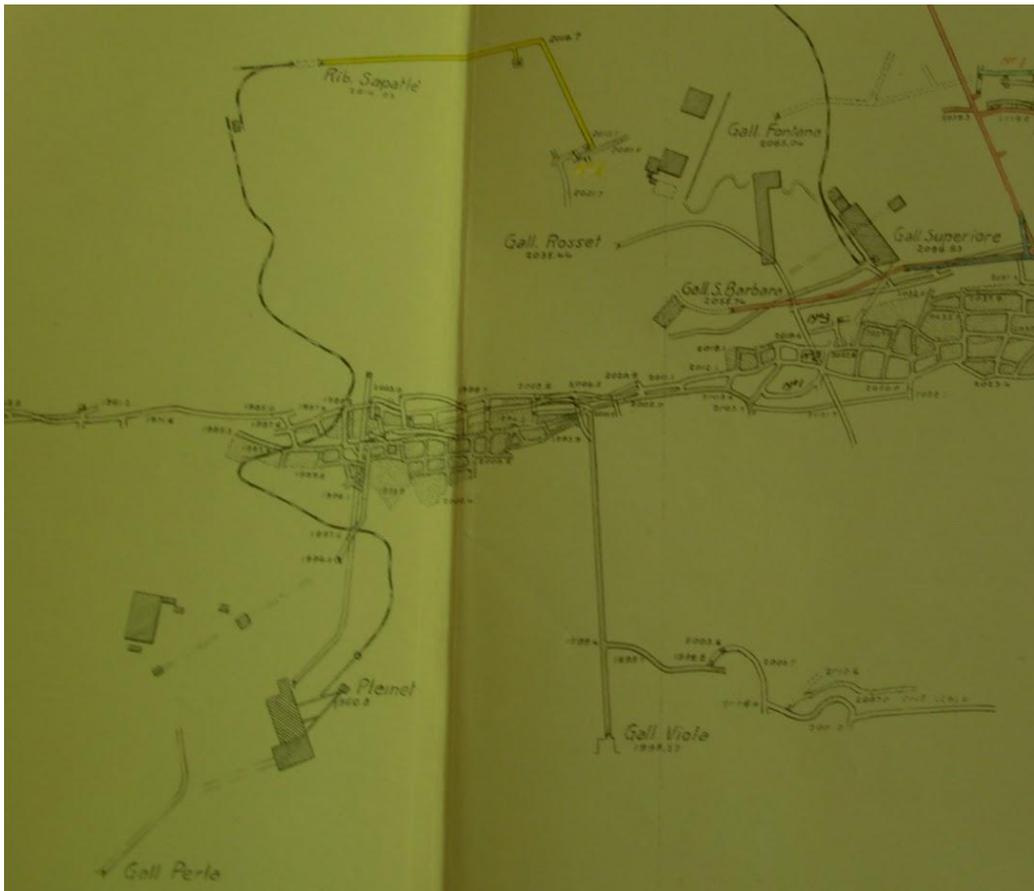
Planimetria sito minerario Pleinet/Sapatlè - (anno 1940)⁵⁸
